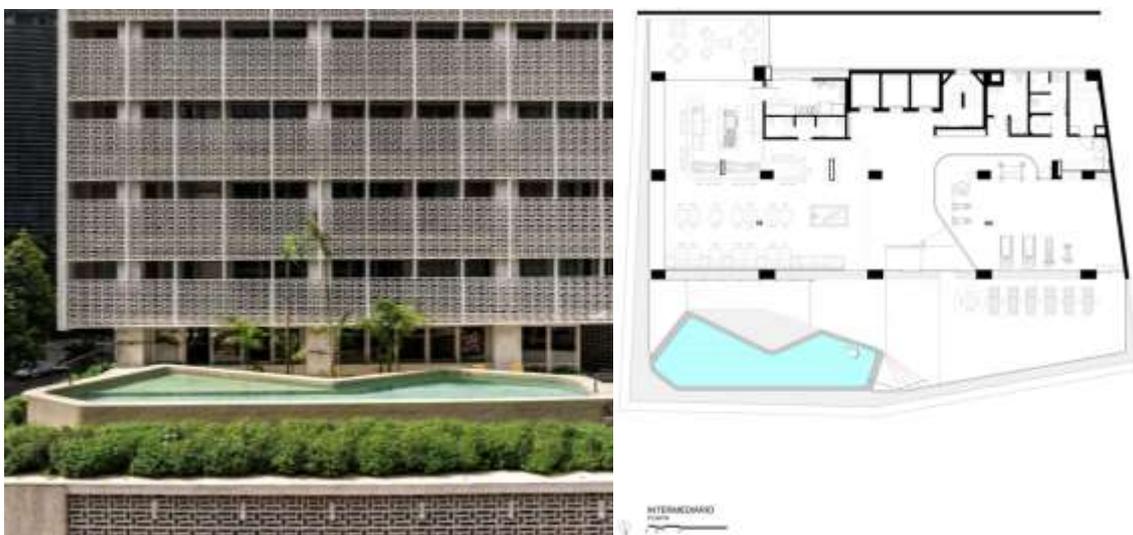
Pavimento Intermediário do Edf. Renata. Fonte: Edifício Renata, Archdaily [s.d]. Disponível em: <https://encr.pw/MDdIT>. acesso em 2025
